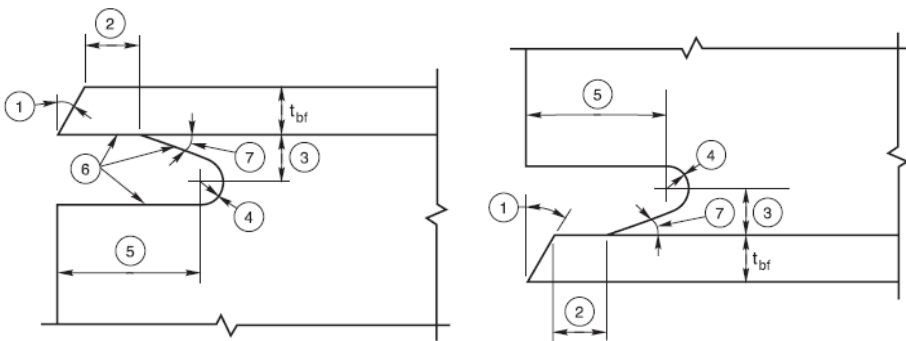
Detalle de agujeros de acceso para la soldadura
